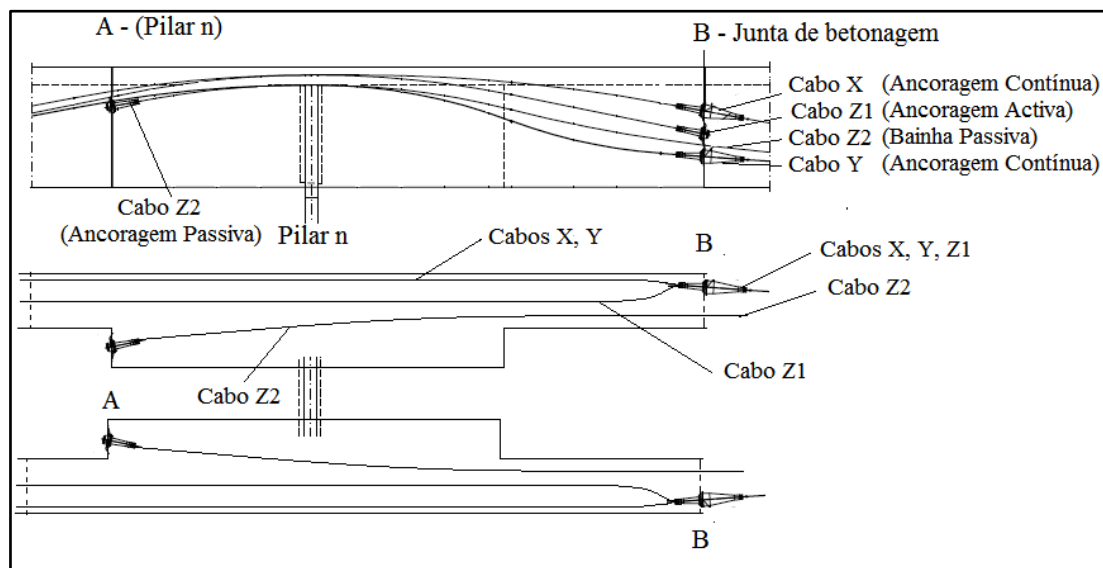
Corte longitudinal (em cima) e planta (em baixo) do traçado dos cabos de pré-esforço no pilar N
